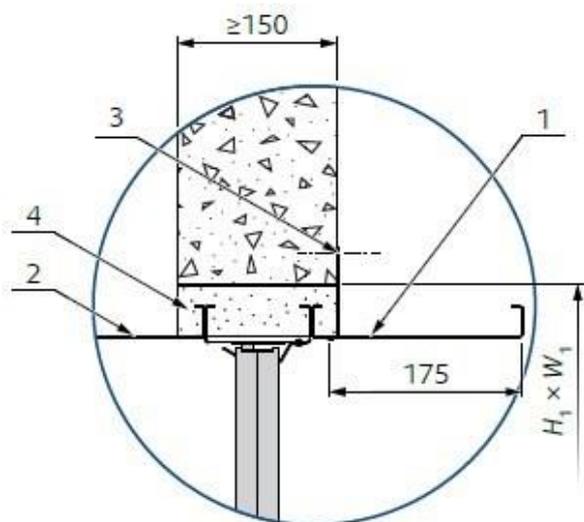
(EI120S) Sezione trasversale per installazione a umido in parete rigida
